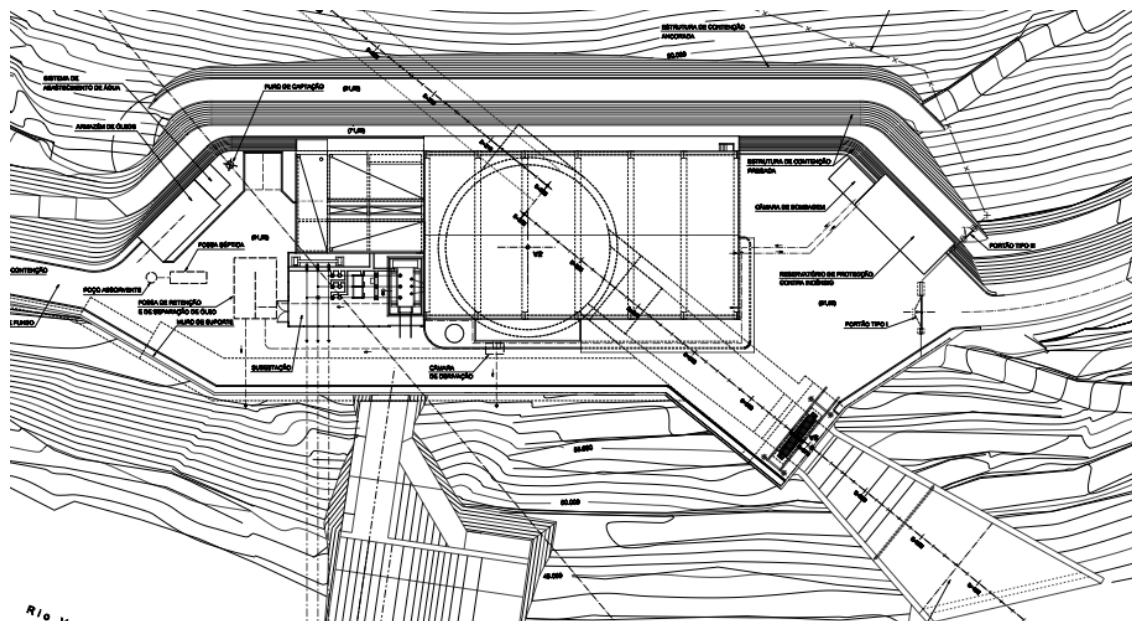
Planta geral da central de Ribeiradio [46]
